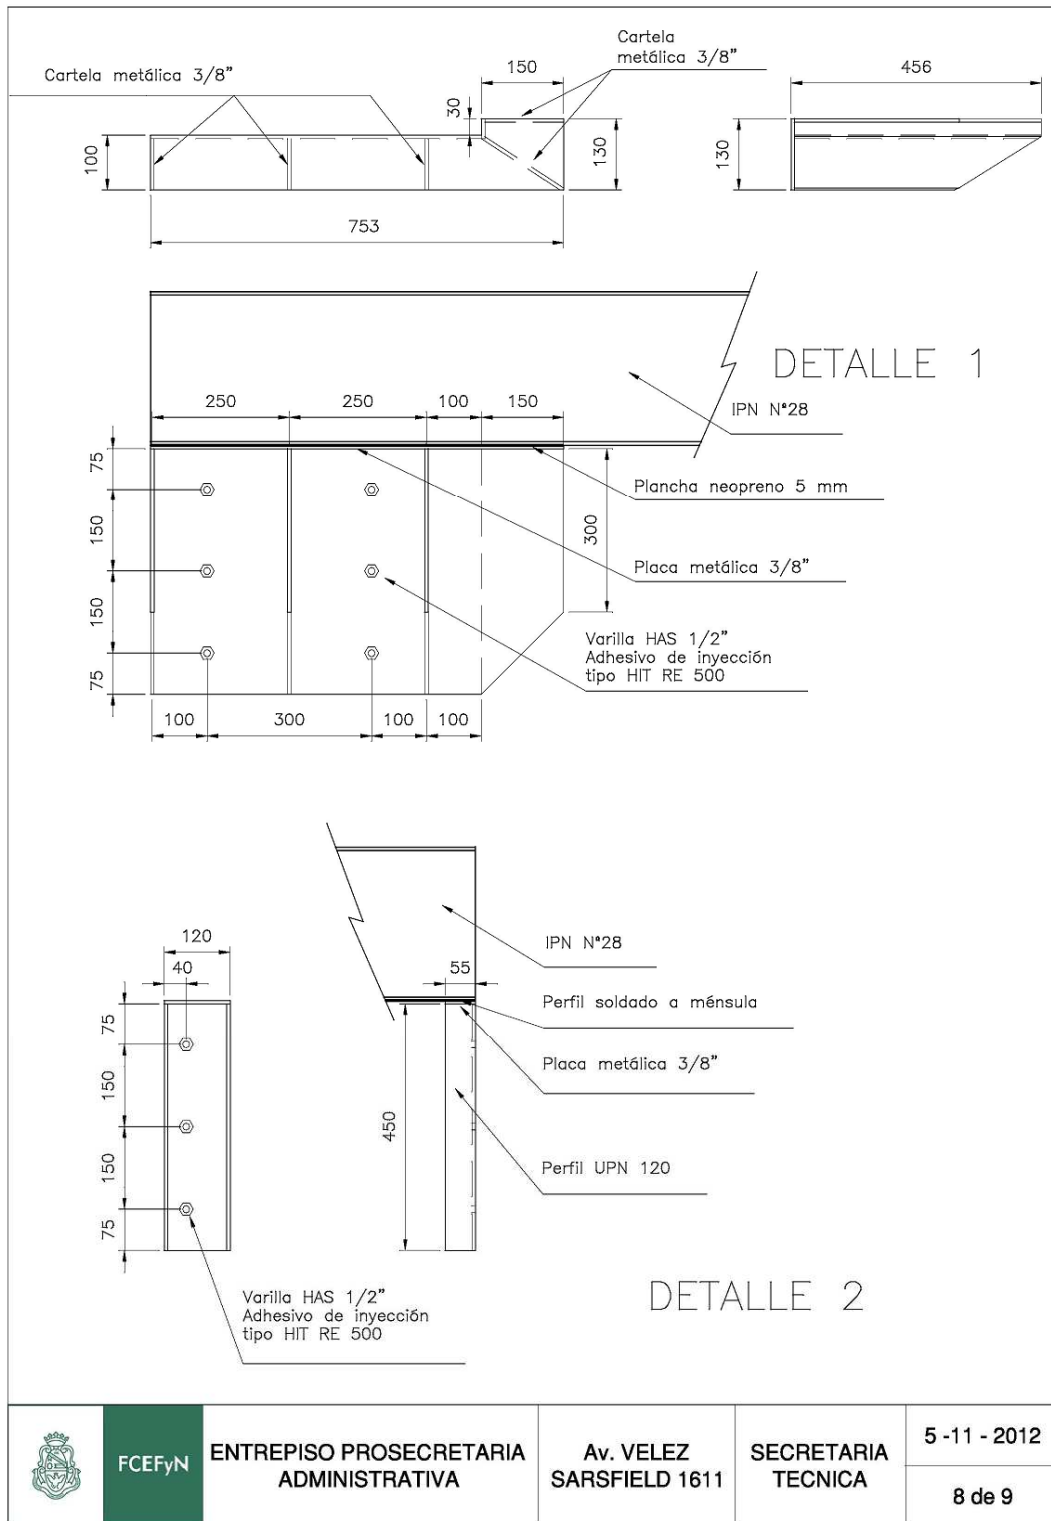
Plano 8 – Fuente: Digitalización de planos originales
